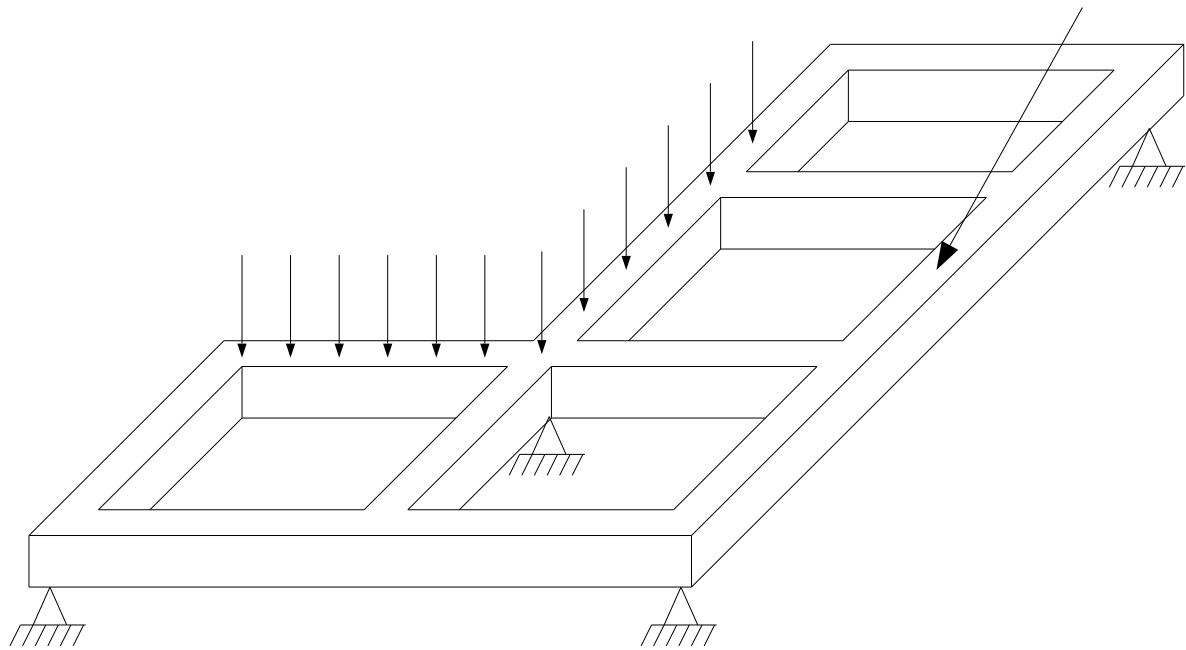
menjelaskan sistem struktur PORTAL beton. Balok menerus seperti pada Gambar 2.2.1.a merupakan konstruksi yang paling sederhana. Elemen balok terletak pada satu sumbu dan menerima beban luar transversal terhadap sumbu tersebut. Sistem struktur seperti pada Gambar 2.2.1.b disebut PORTAL BIDANG. Semua unsur elemen struktur berada dalam bidang portal. Demikian juga halnya dengan beban luar yang bekerja. Struktur GRID seperti Gambar 2.2.1.c mempunyai unsur elemen pada suatu bidang datar dan semua beban luar bekerja transversal pada bidang tersebut. PORTAL RUANG seperti pada Gambar 2.2.1.d merupakan pemodelan tipe struktur portal yang ideal bagi sistem struktur kerangka, karena pemodelannya berupa sistem struktur dalam ruang (tiga dimensi), seperti sistem struktur bangunan yang sesungguhnya.
